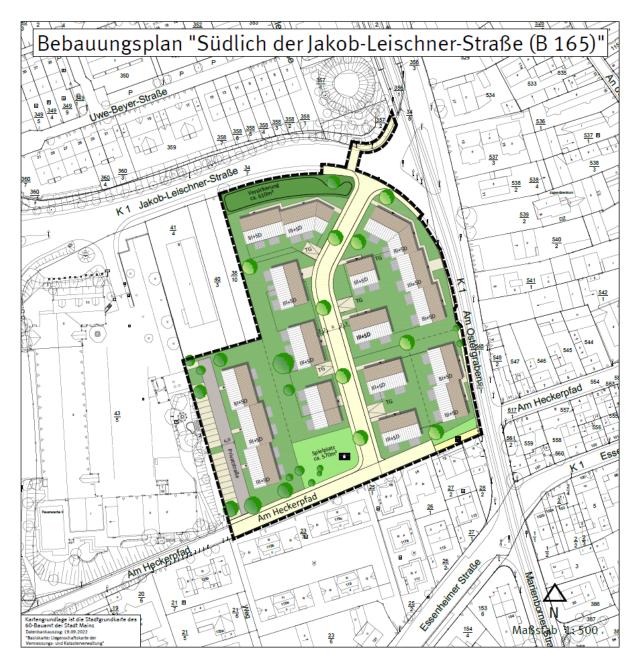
Städtebaulicher Entwurf zum Bebauungsplan "Südlich der Jakob-Leischner-Straße (B 165)" Stand Planstufe I, 30.09.24 [2]
